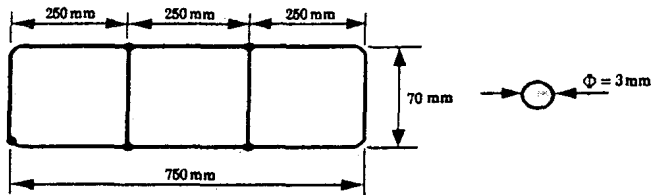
埋入光纤传感阵列的混凝土构件配筋示意图
